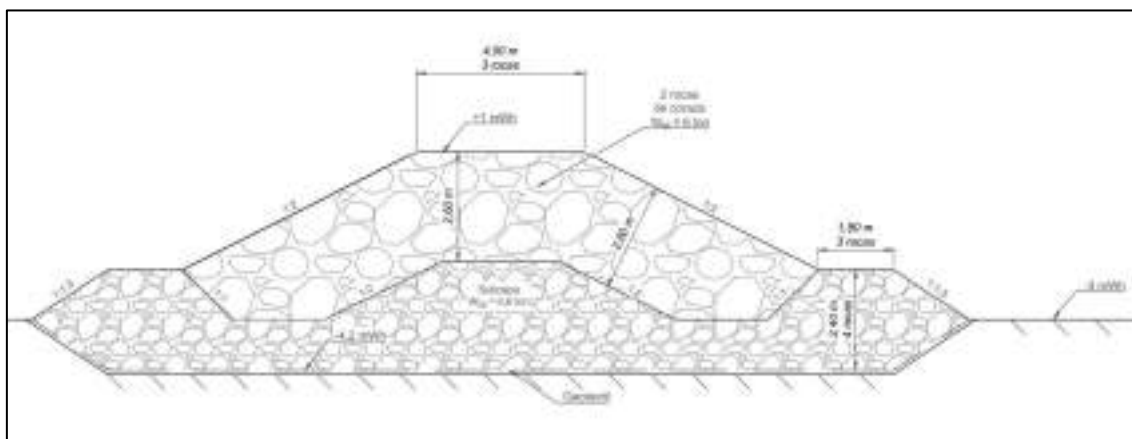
Sección tipo del tramo más expuesto del espigón norte de la Alternativa 1.
